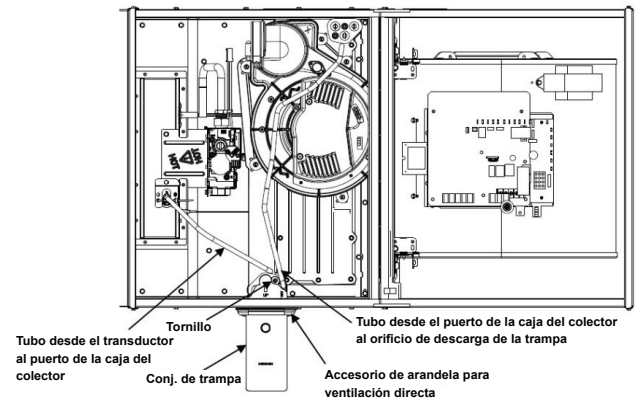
Horizontal izquierda: Auxiliar de montaje de la trampa
